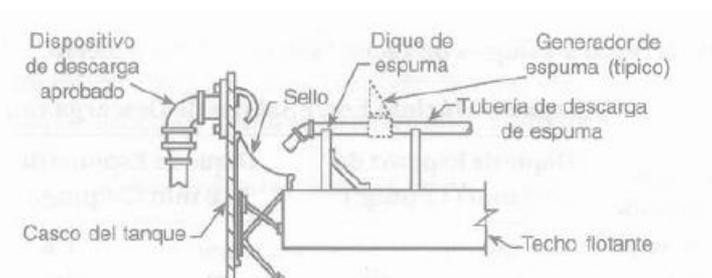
Descarga de espuma por encima de zapata metálica (63)
